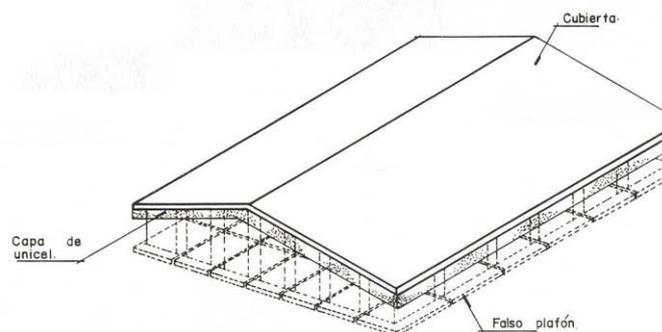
Cubierta de una caseta con aislamiento térmico en donde el "unicel" ha sido adherido directamente en él. En línea punteada está proyectado un falso plafón, lo cual constituye una segunda opción.
